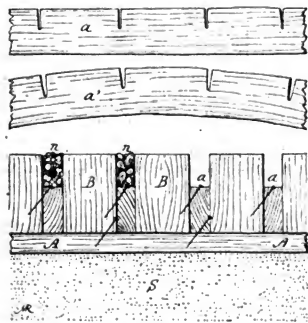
Coupe verticale d'un pavage en bois, avec lattes.
